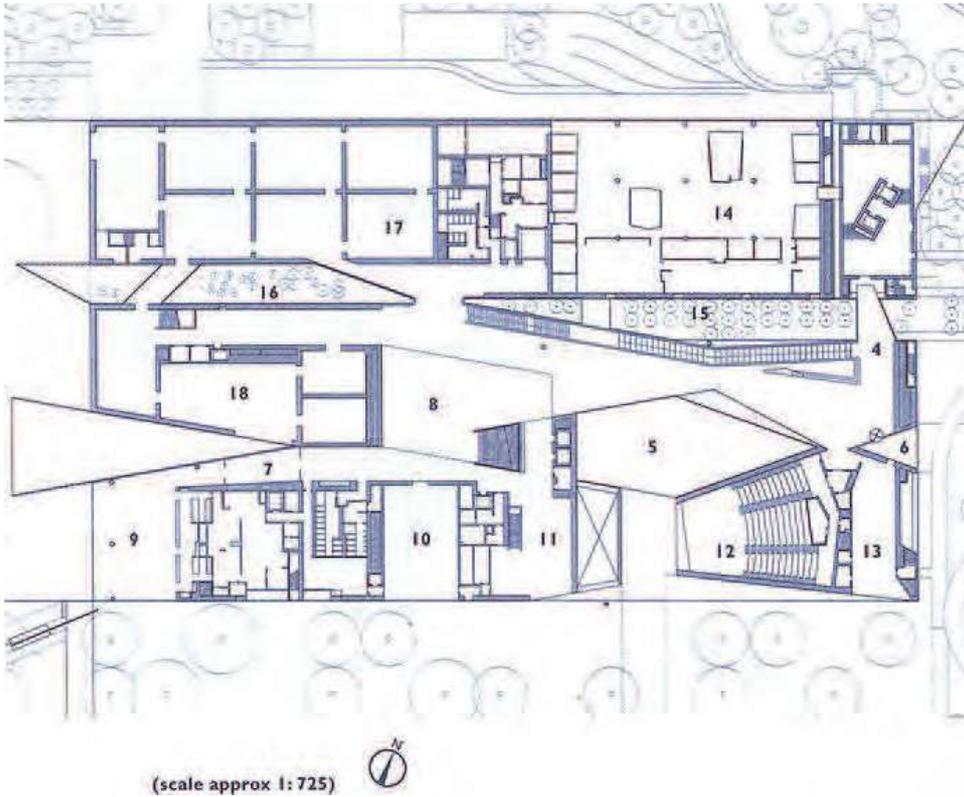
Museo de Young, San Francisco, Planta arquitectónica 1
